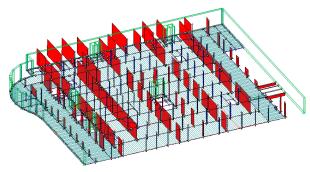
Diagramas axiles. Planta Mezzanine (PS1).
